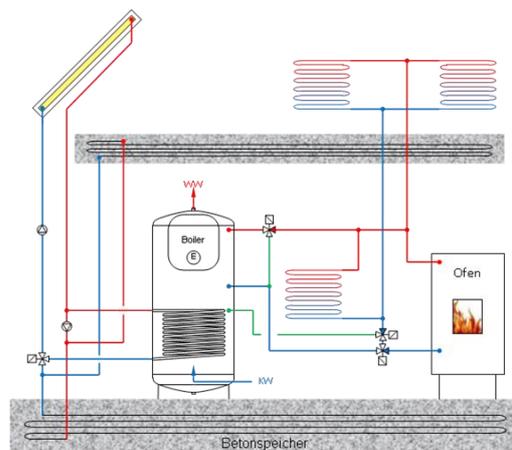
Schema Betonkernaktivierung u. Zimmerofen; www.energie-werkstatt.at
